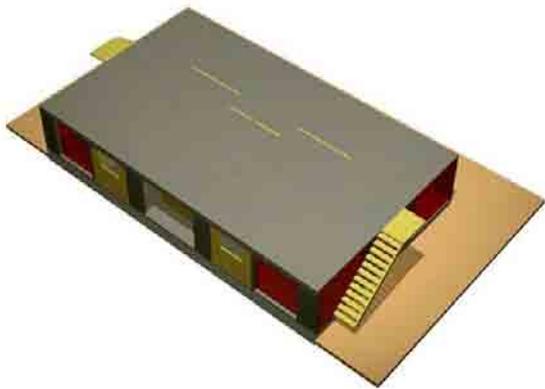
Losa de hormigón armado sobre casas bajas. Fuente: www.elmentalchile.org
